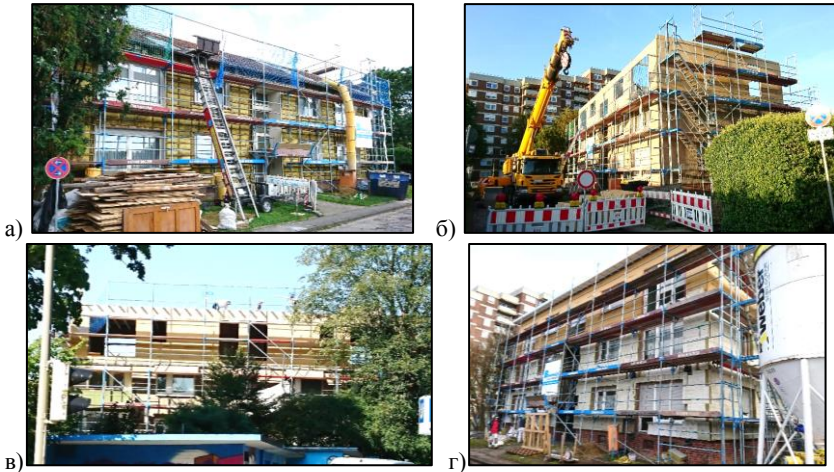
Реконструкція житлового будинку з надбудовою поверху та термомодернізацією: а – розбирання конструкцій зовнішнього оздоблення, наявного утеплювача та шатрового даху; б – надбудова 3-го поверху; в – влаштування плоского даху; г – влаштування «нової» теплоізоляції
